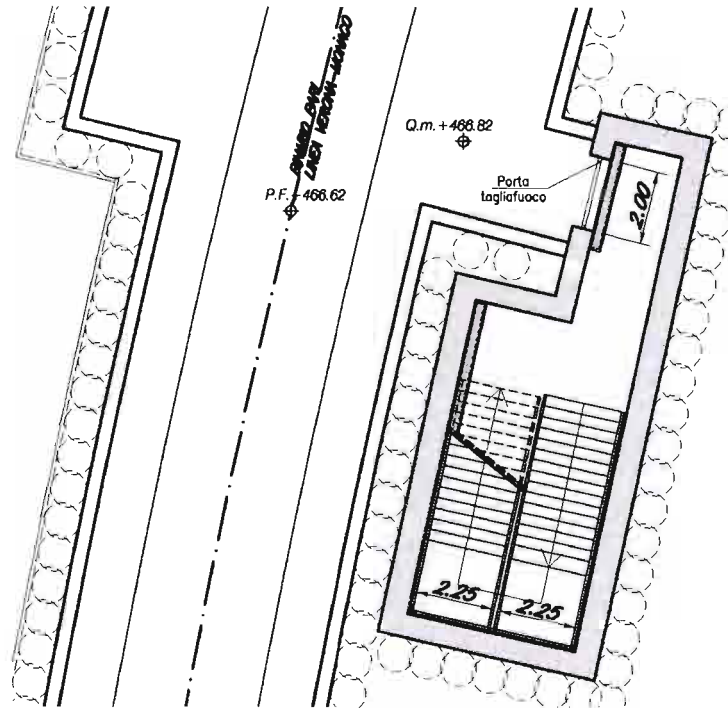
Pianta scala Interconnessione Ponte Gardena
